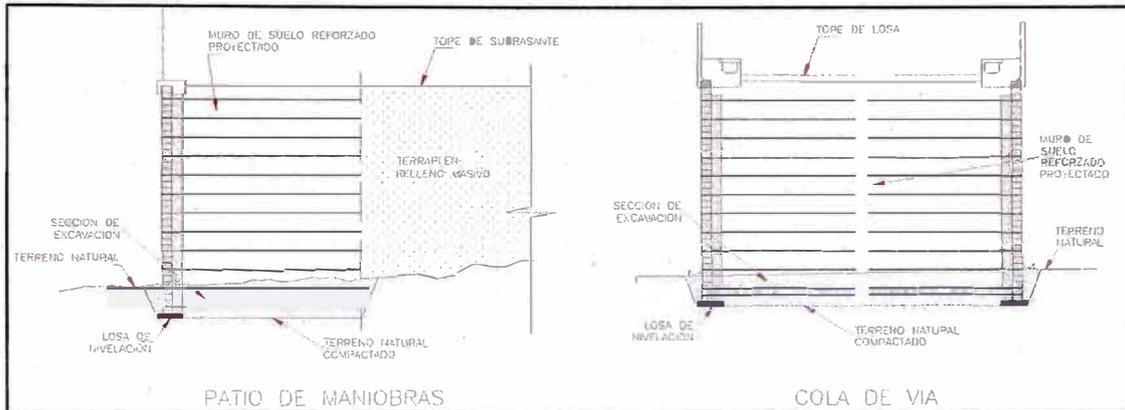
Muro de suelo reforzado – Secciones típicas de Excavaciones.
